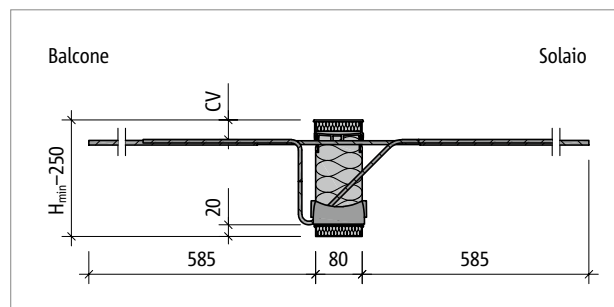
Schöck Isokorb® T tipo K-M5 e K-M6: sezione del prodotto
